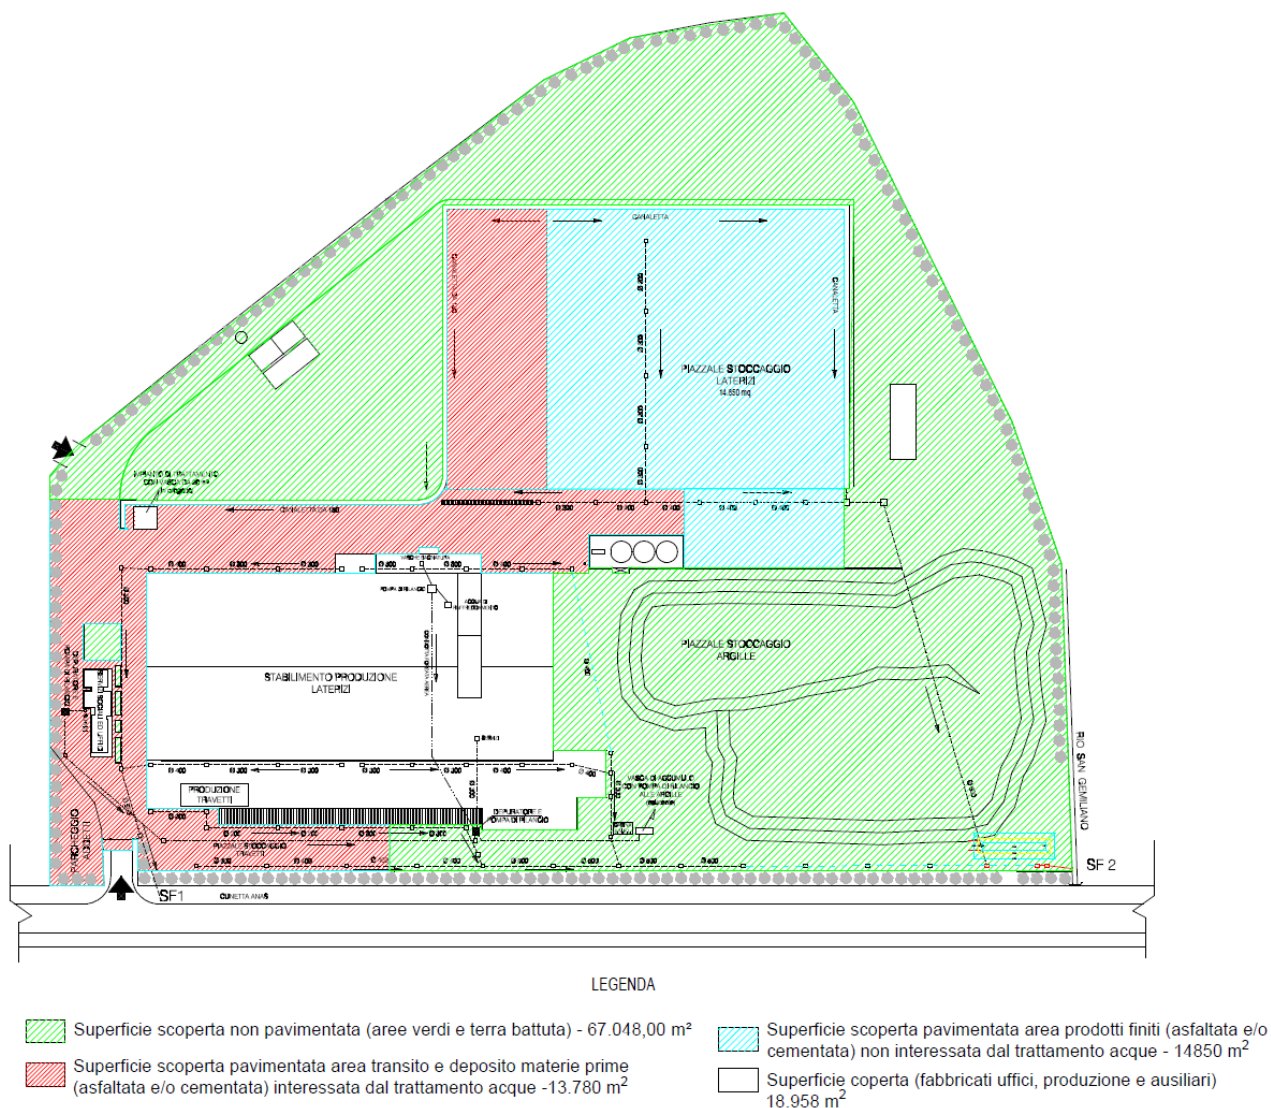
Modifica alle superfici interessate dall'impianto di trattamento acque prima pioggia (campite in rosso)
